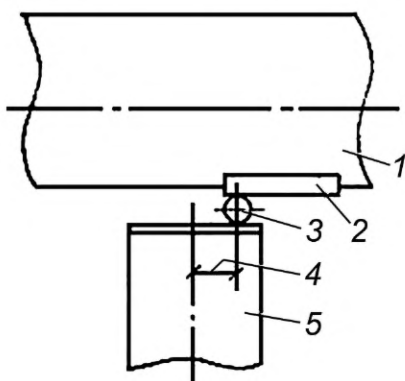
Распределение вертикальной нагрузки по поперечному сечению трассы при расчете пролетных строений, колонн и фундаментов эстакад
